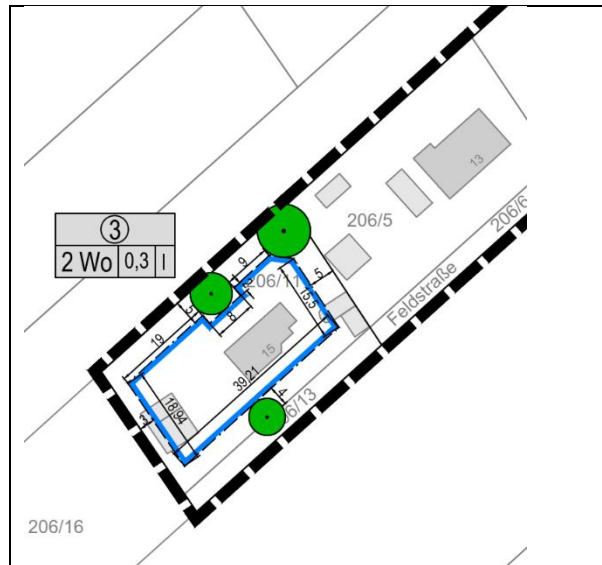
Hausnummer 15 - Lageplan (o.M.)
